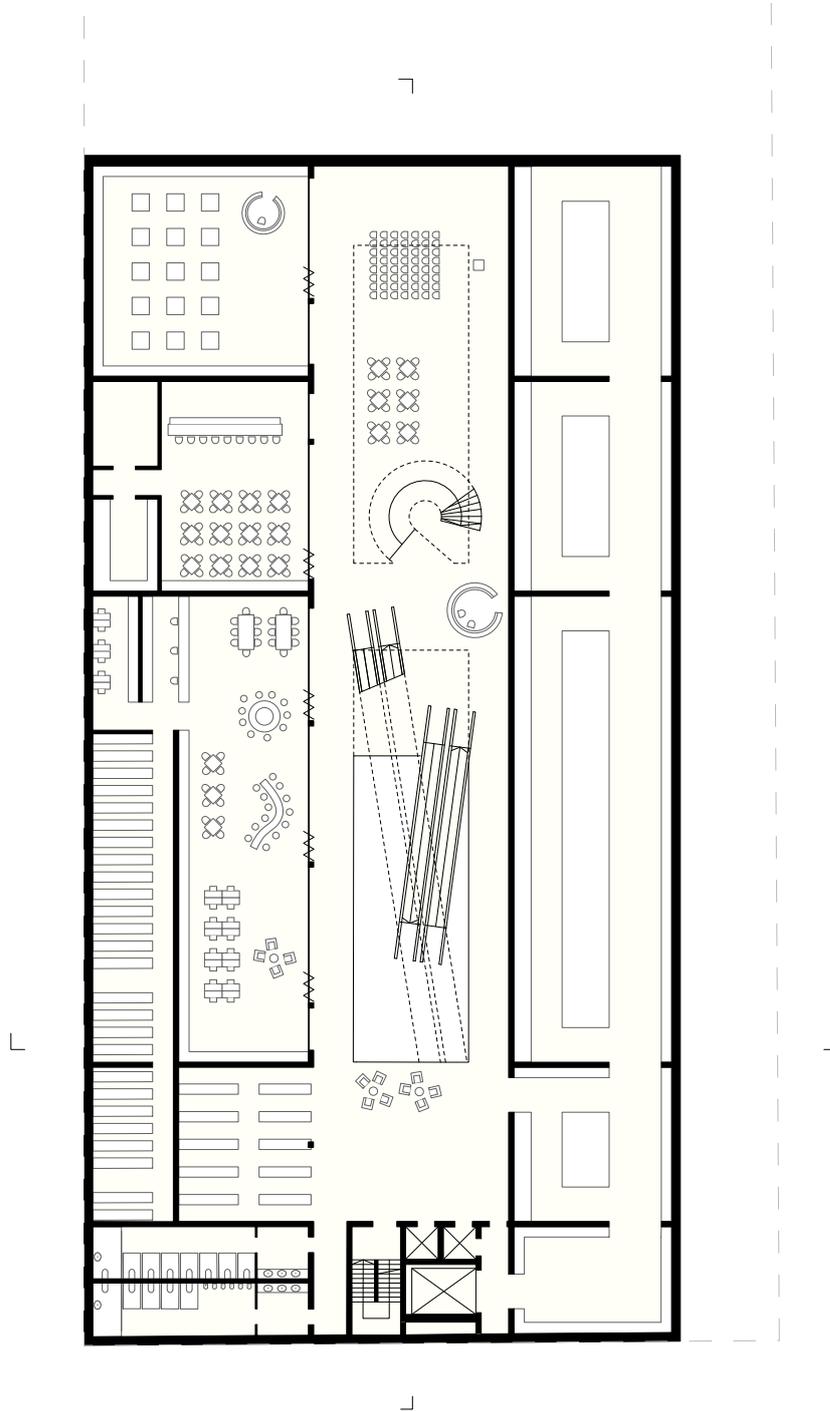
Wettbewerbsbeitrag Grundriss Untergeschoß 2
